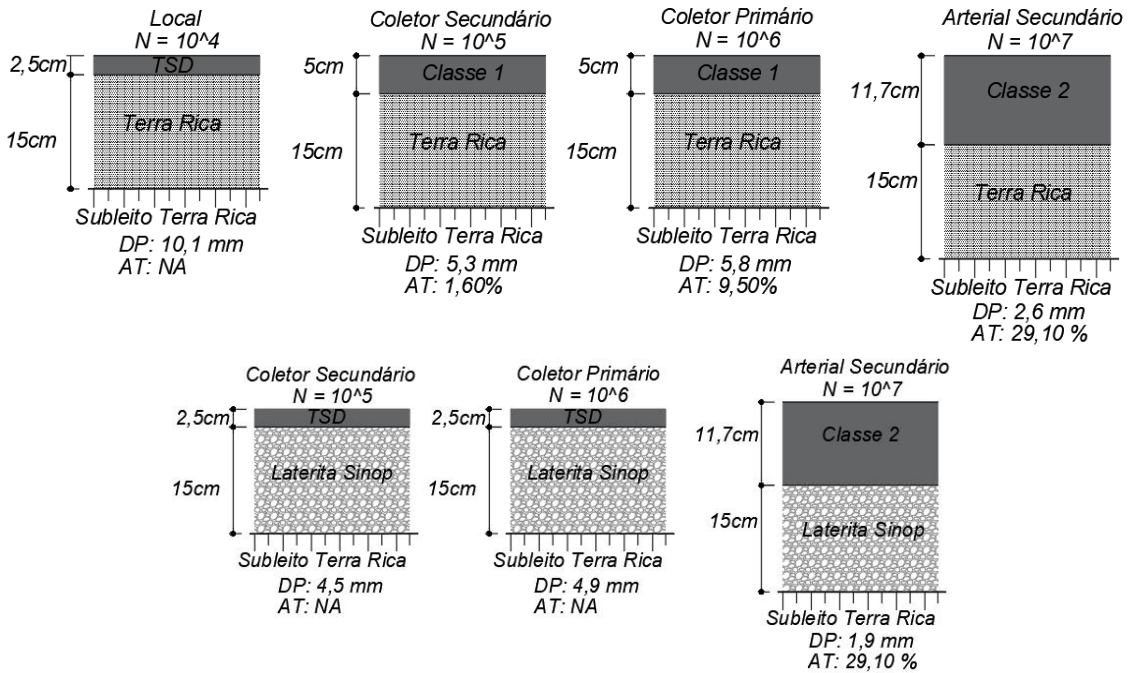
Estruturas de pavimentos dimensionadas com o solo Terra Rica e Laterita Sinop
